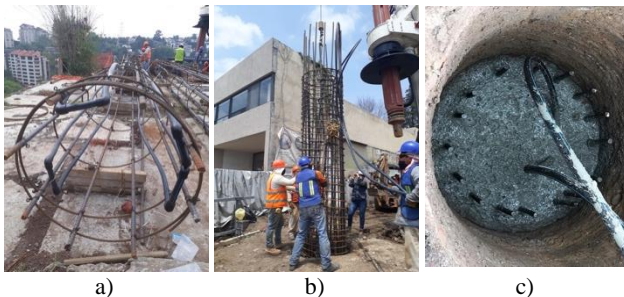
Pila de energía sometida a prueba TRT: a) Colocación de la tubería en el armado. b) Colocación del armado en el suelo. c) Pila de energía colada *in situ* con extremos de tubería en la cabeza de la pila.
